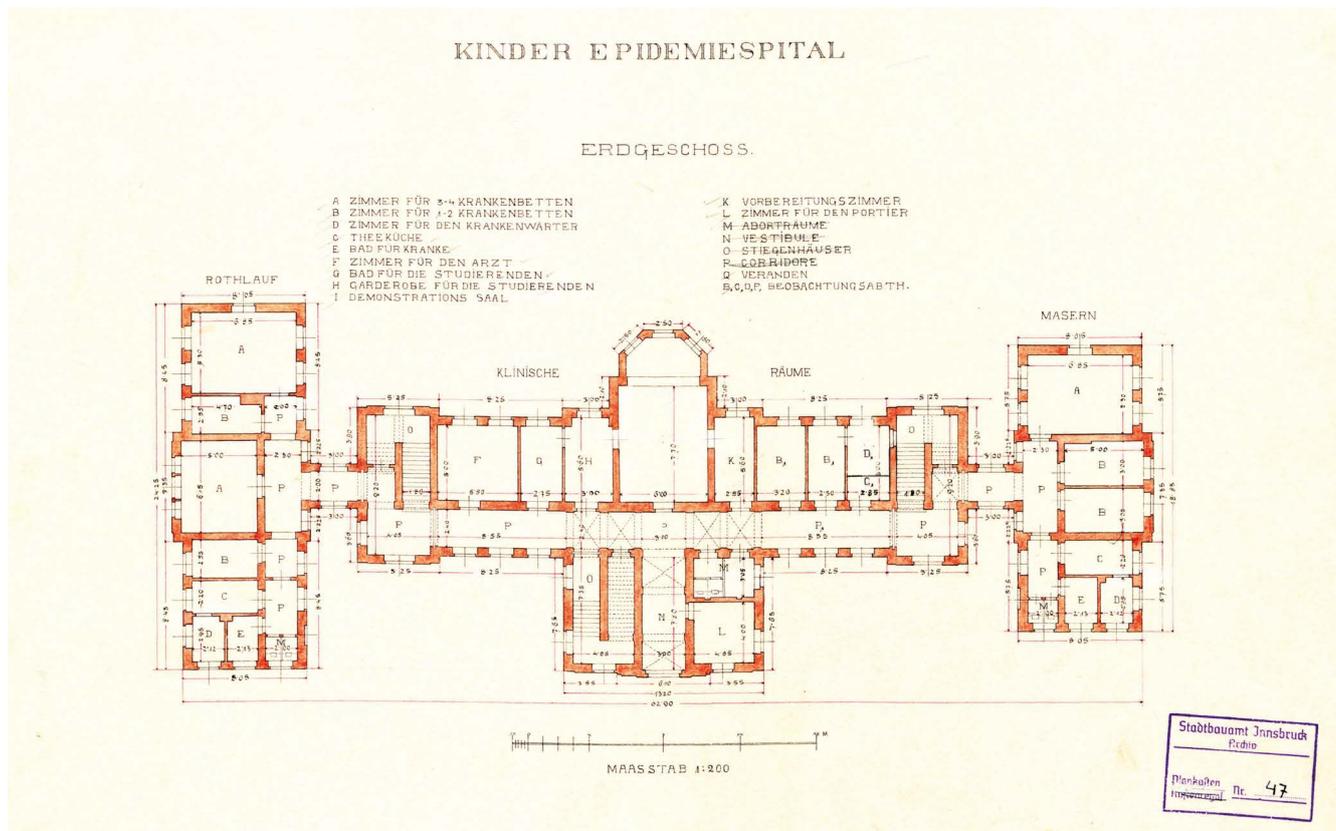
Grundriss für das Erdgeschoss im Kinder-Epidemiespital.
